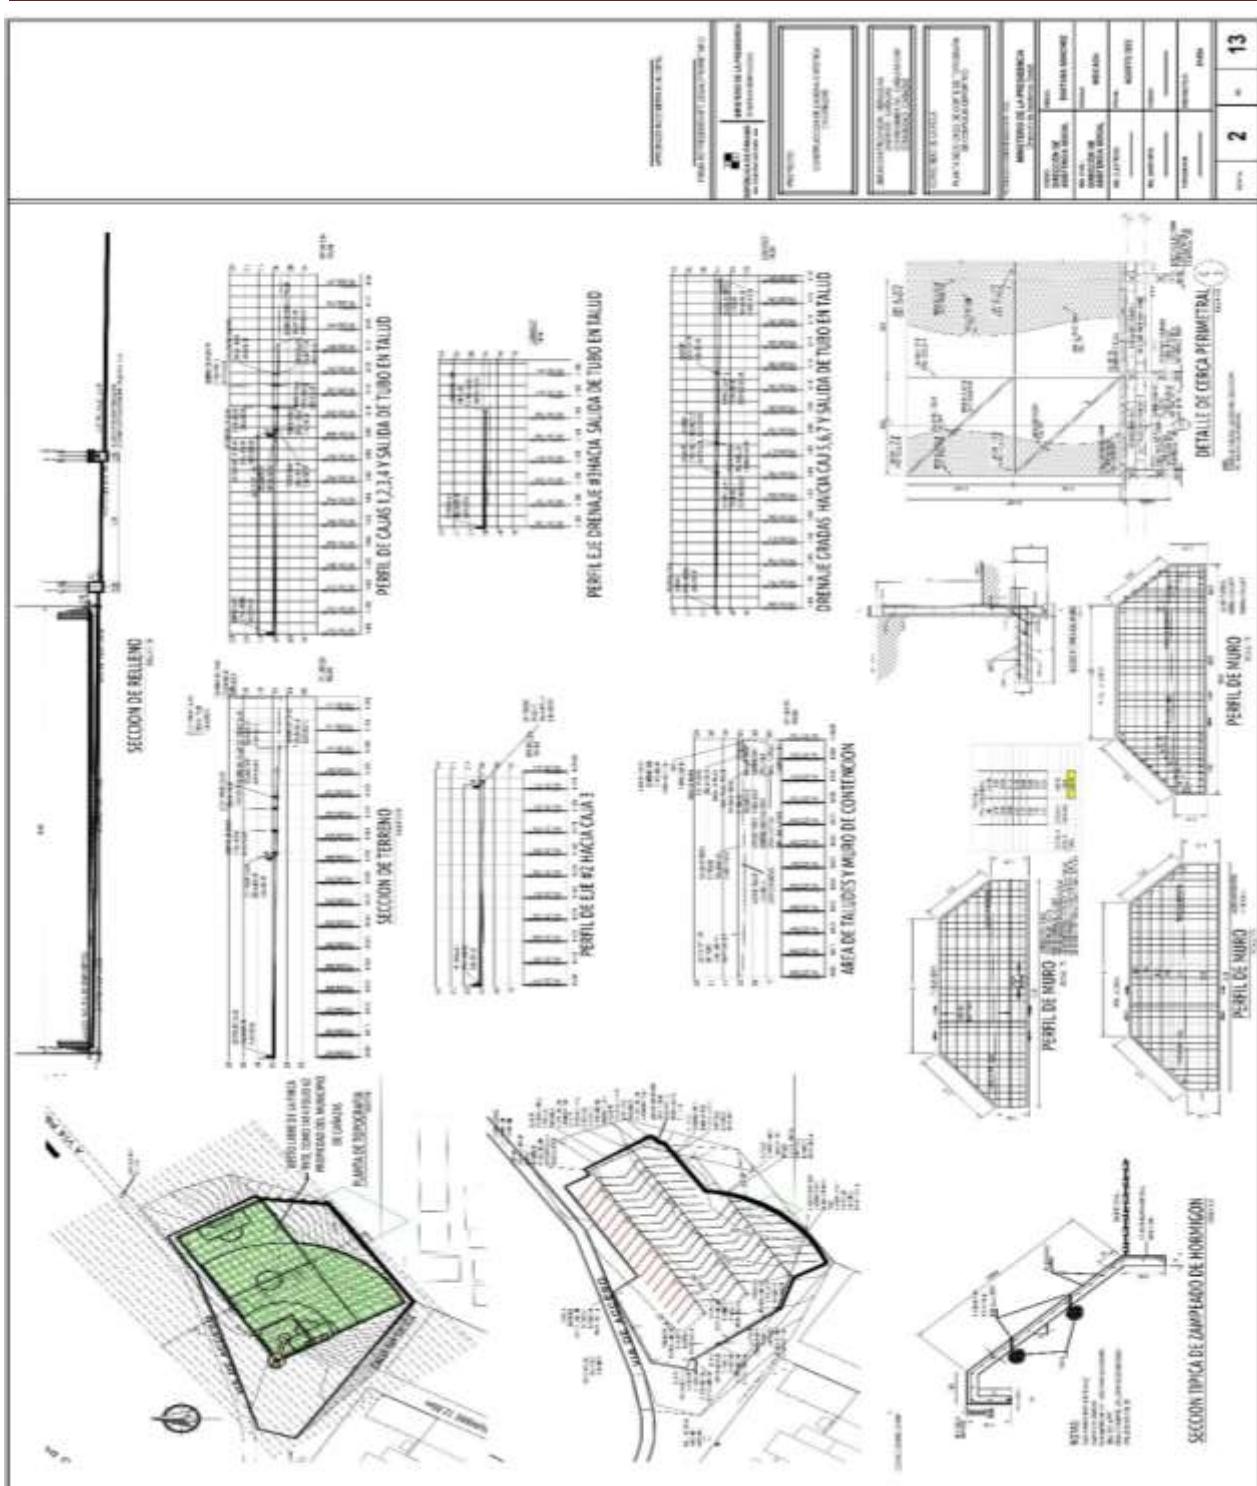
Planta arquitectónica: topografía (sección de terreno, perfil de cajas 1,2,3,4,, perfil de salida de tubo en talud, perfil de eje #2 y 3, perfil de talud y muro de contención, drenaje gradas hacia cajas 5,5 y salida de tubo en talud, perfil de muro y detalle de cerca perimetral).
